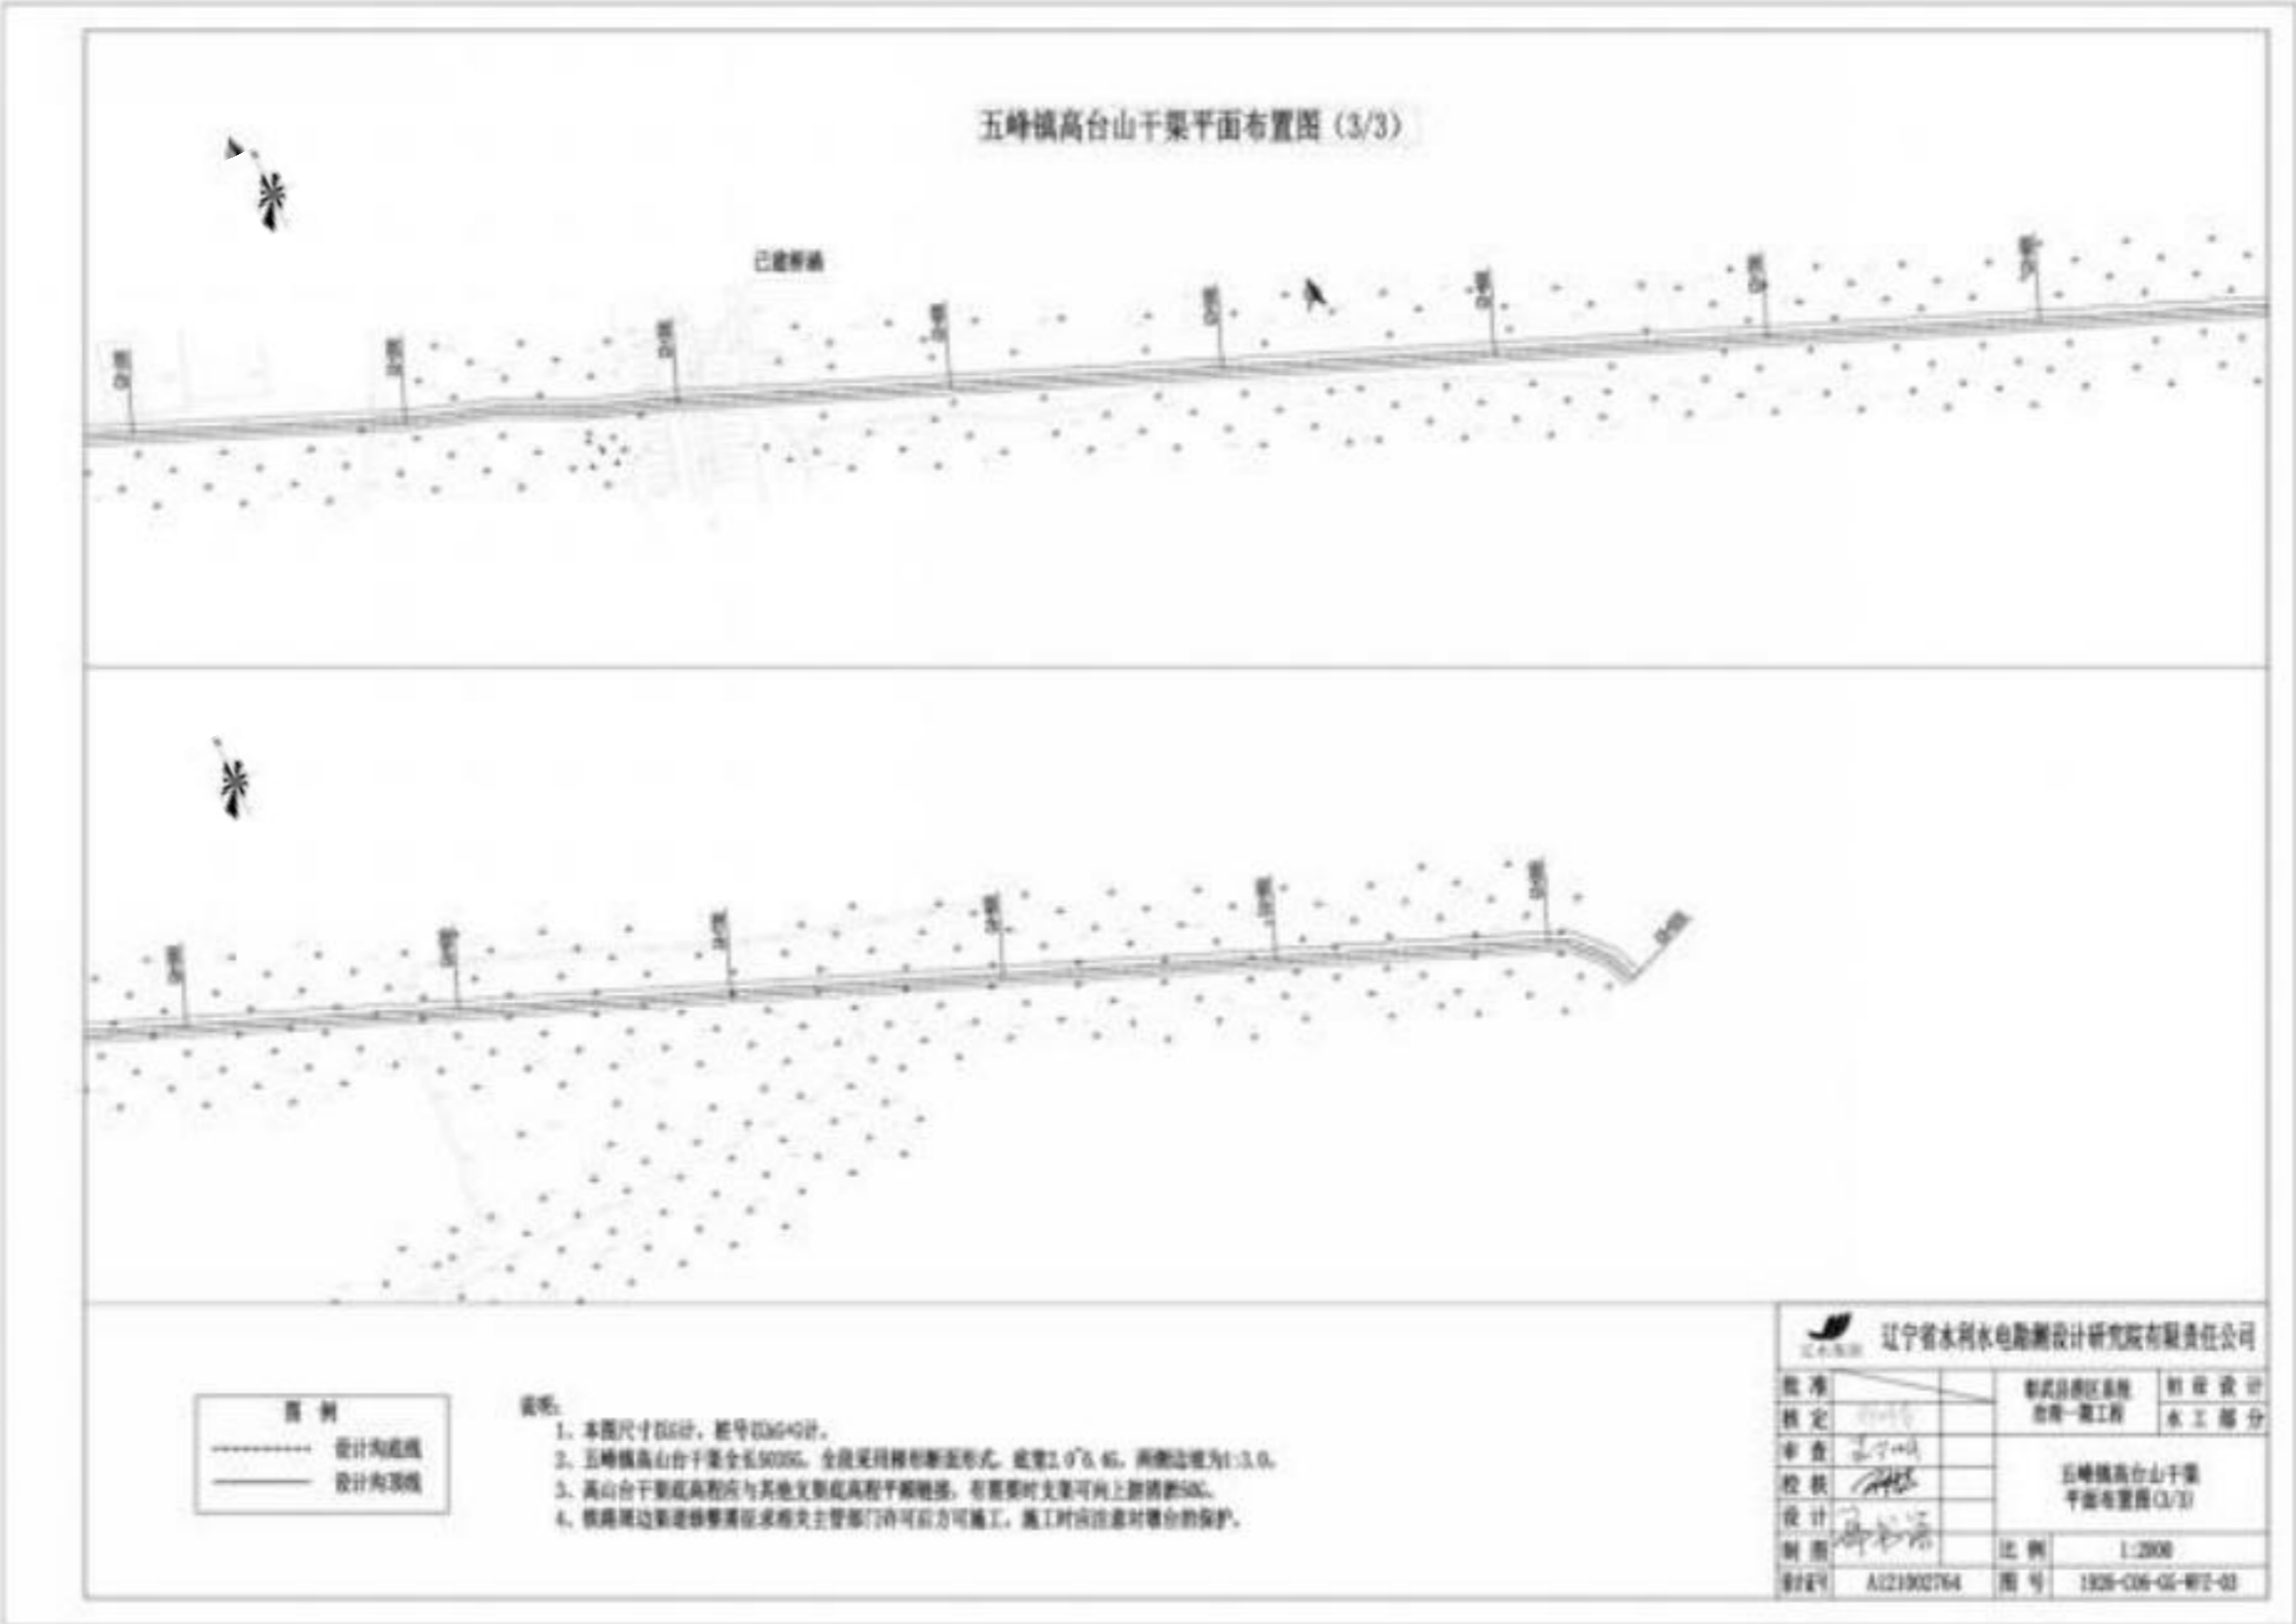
(3) 五峰镇高山台干渠平面布置图
